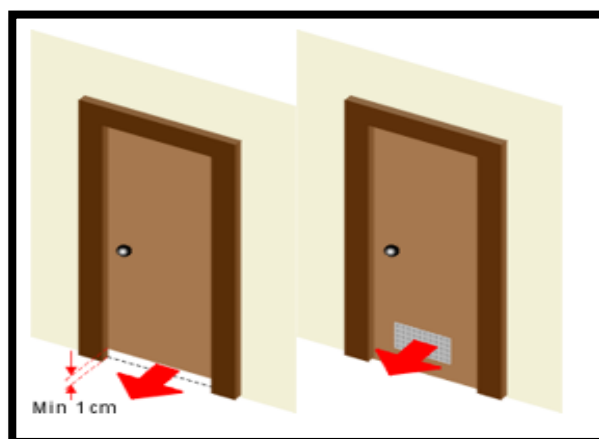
Transfert d'air au travers d'une porte ou par détalonnage
